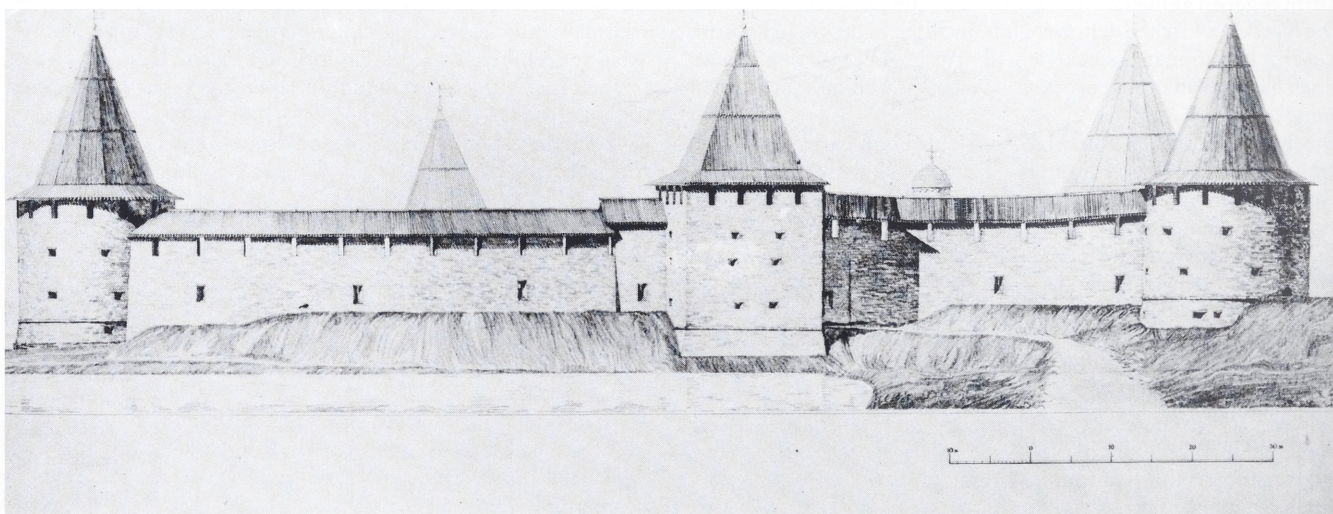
Ladoga-Festung. Westfassade. Rekonstruktion laut Kostenplan von 1647 durch O. Gussewa, M. Koljada und M. Miltschik und I. Petrunina.
